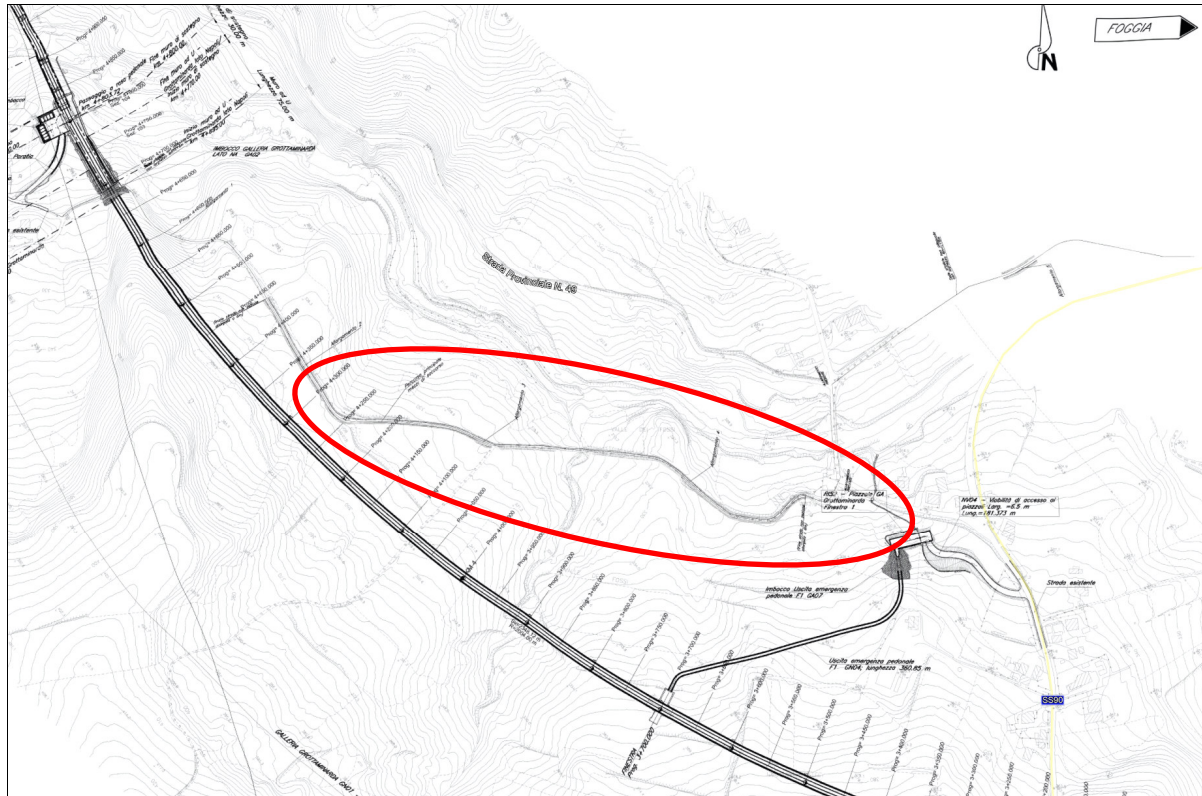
Stralcio planimetrico con l'individuazione dell'intervento
